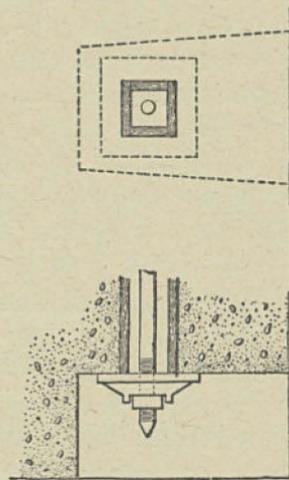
Echancreure dans la fondation, pour placer la rondelle.
